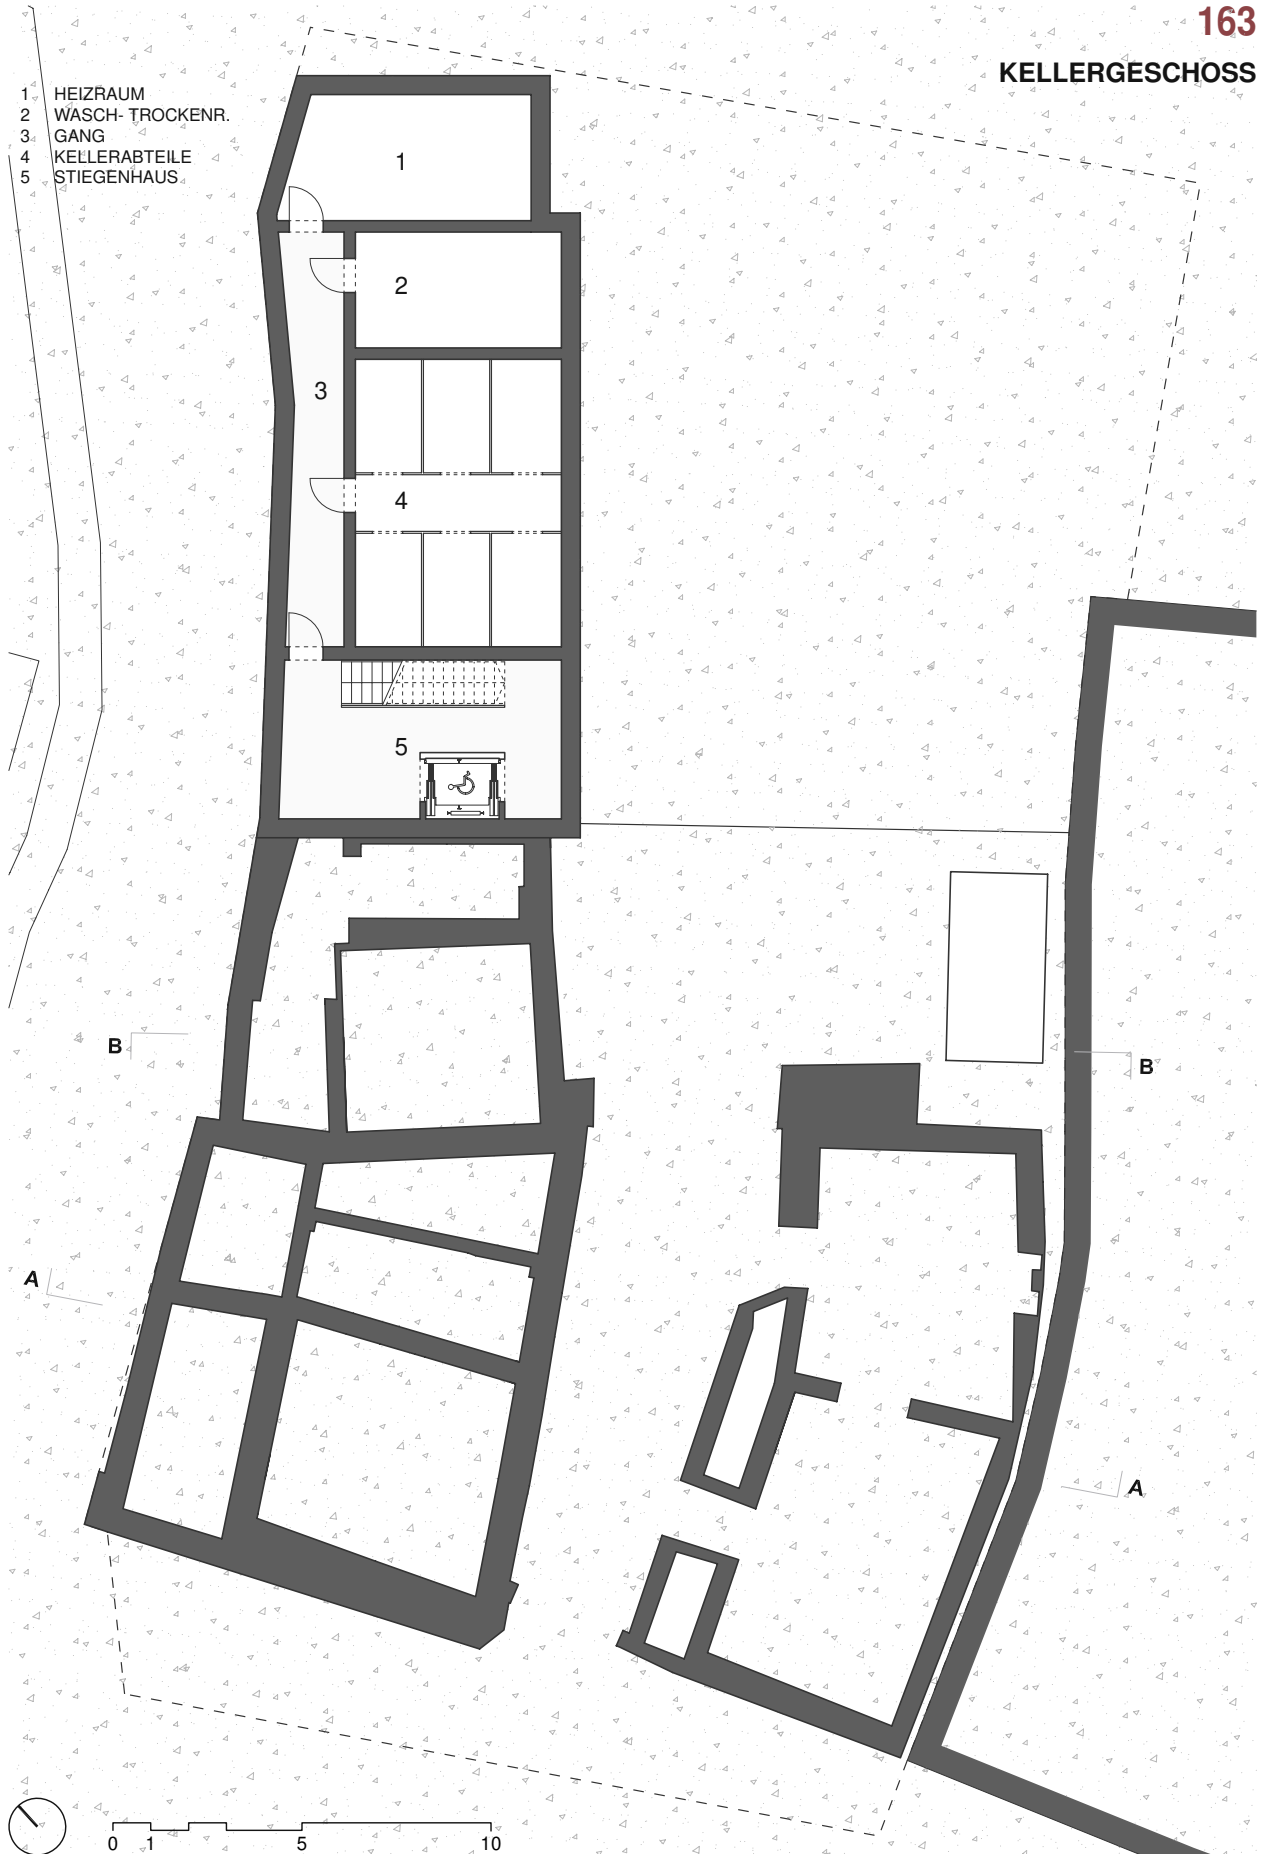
Entwurfsplan Grundriss Kellergeschoß M 1:200
